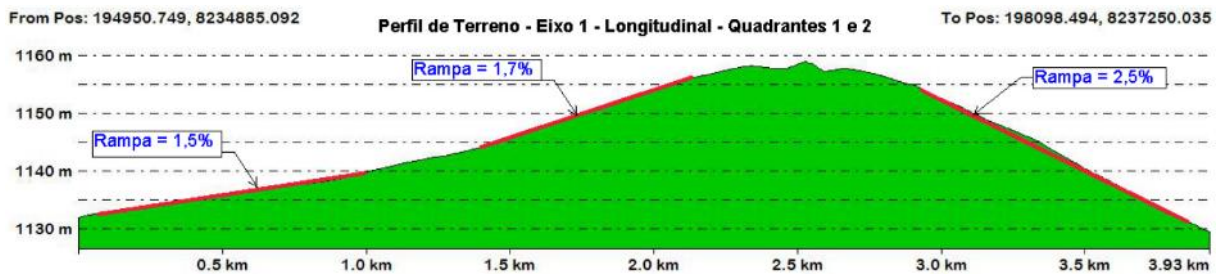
Perfil Longitudinal do Terreno – Eixo 1
